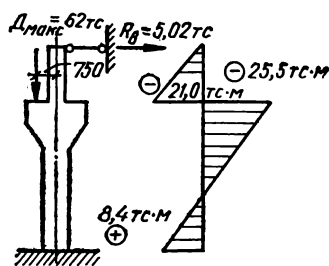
Расчетная схема и эпюра M от вертикальной крановой нагрузки для колонны по оси B .
